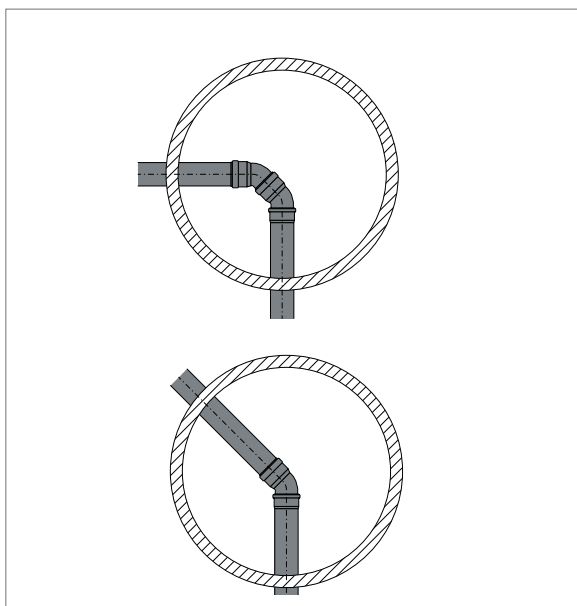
Zmeny smeru pri zberných a základných potrubíach
